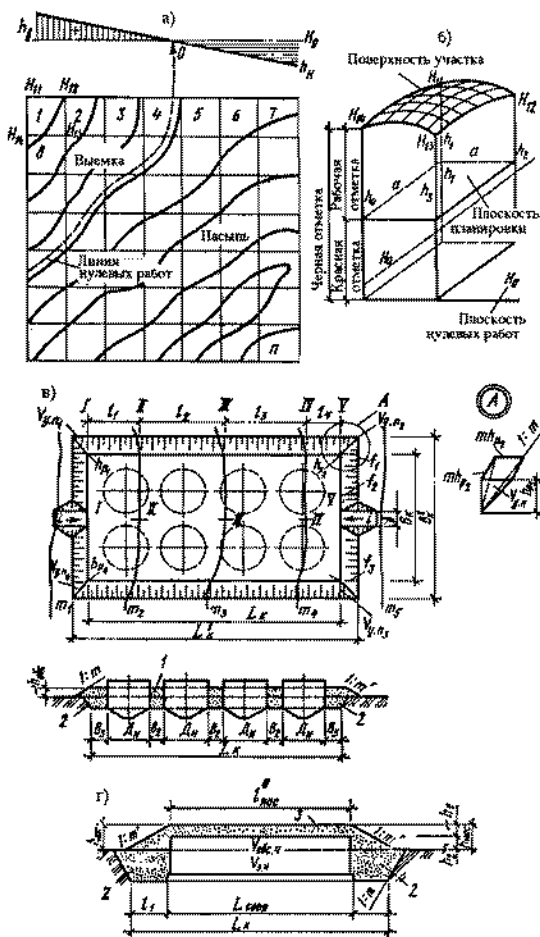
Схемы к подсчету объемов вертикальной планировки, засыпки и обсыпки сооружений: а - разбивка площадок на квадраты; б - положение плоскостей при планировке; в - план котлована и его продольное сечение для определения объема засыпки и обсыпки после возведения сооружений без покрытий; г - то же, для сооружений с покрытиями
